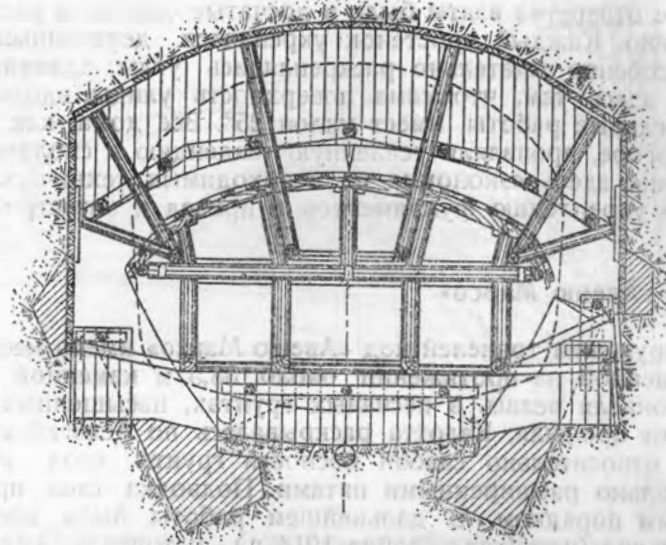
Реконструкция обрушенной тоннельной обделки.
